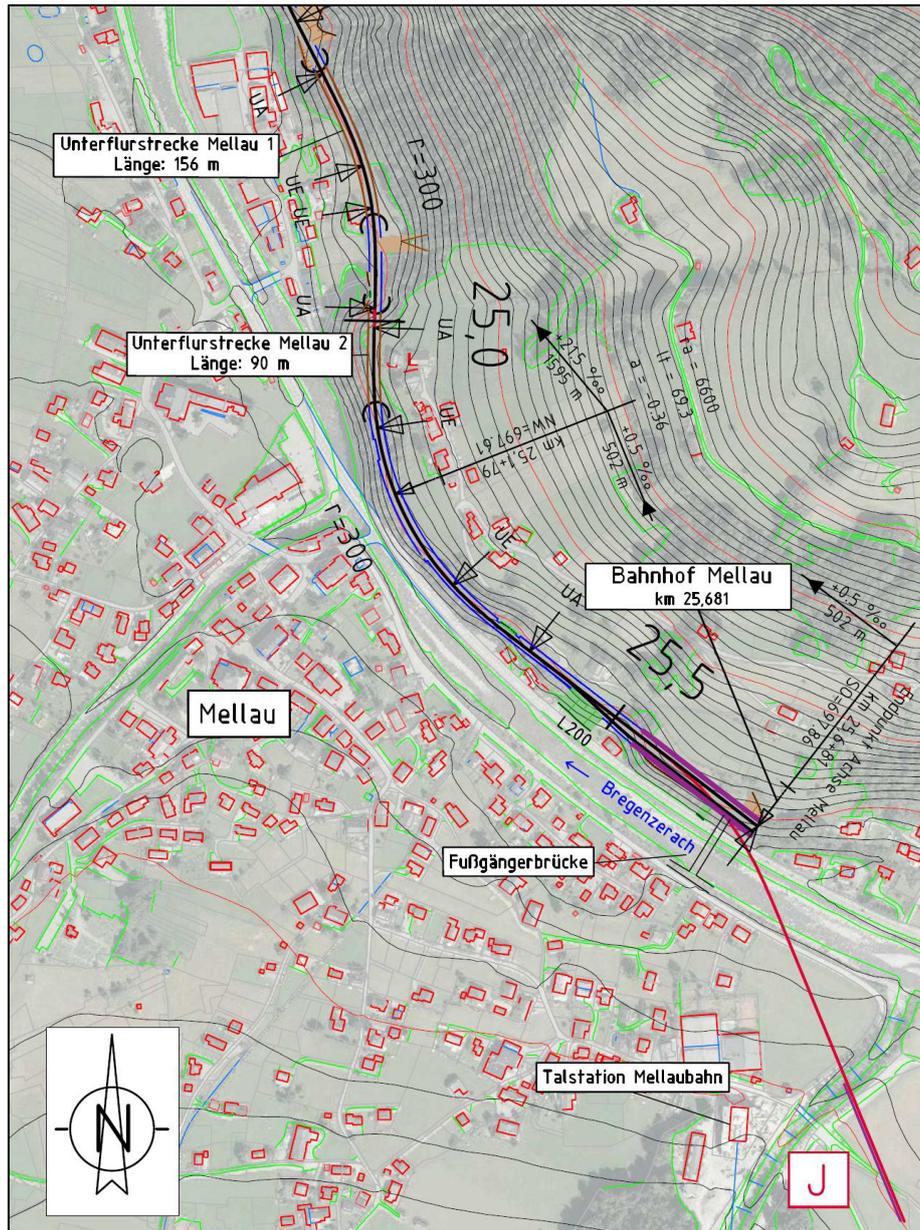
Detaillageplan Bahnhof Mellau mit Variante J
